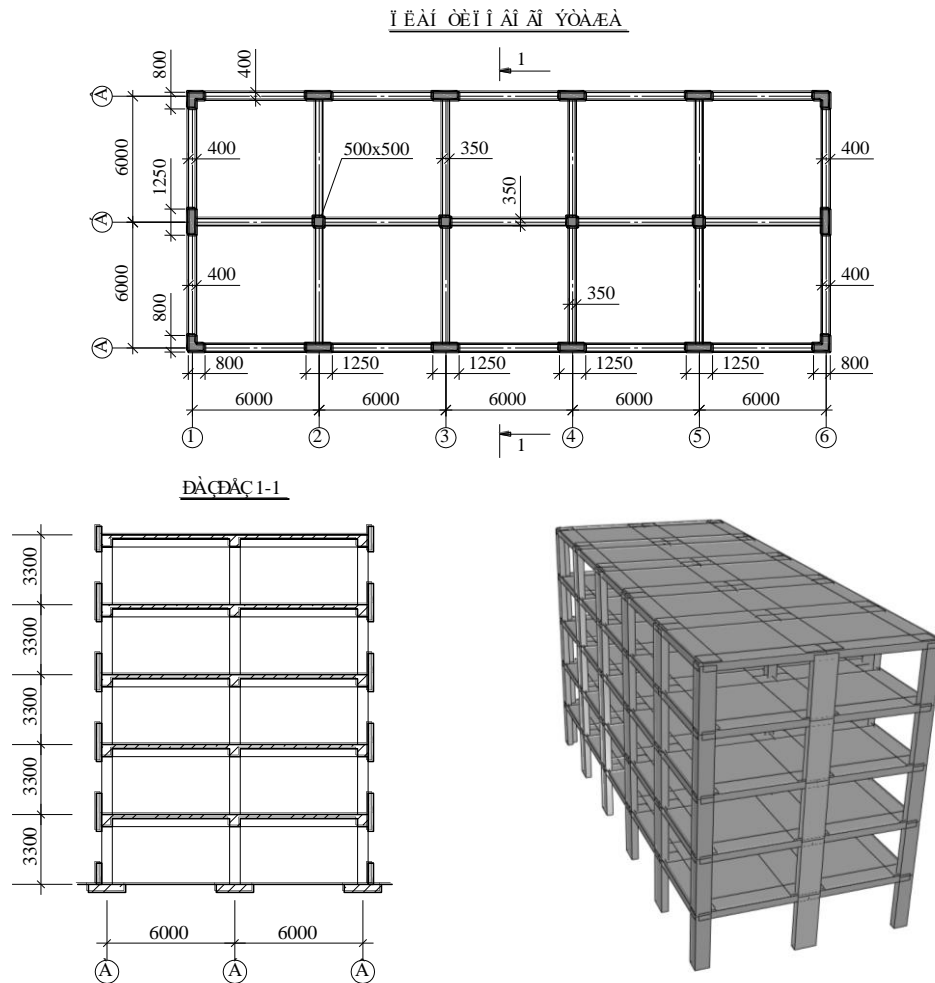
Схематический план, разрез и общий вид каркаса здания
